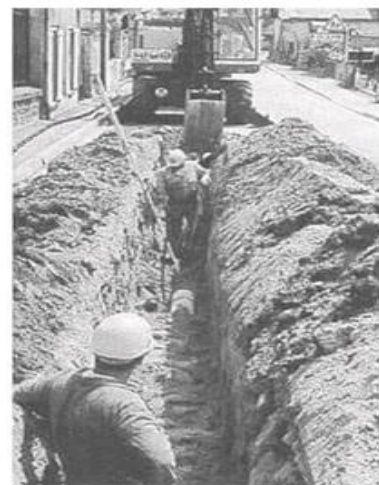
Pose de conduite dans un terrain ordinaire.
